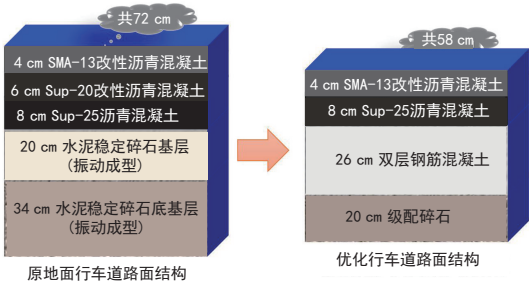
姚庄园区路段优化双层钢筋混凝土基层路面结构图
